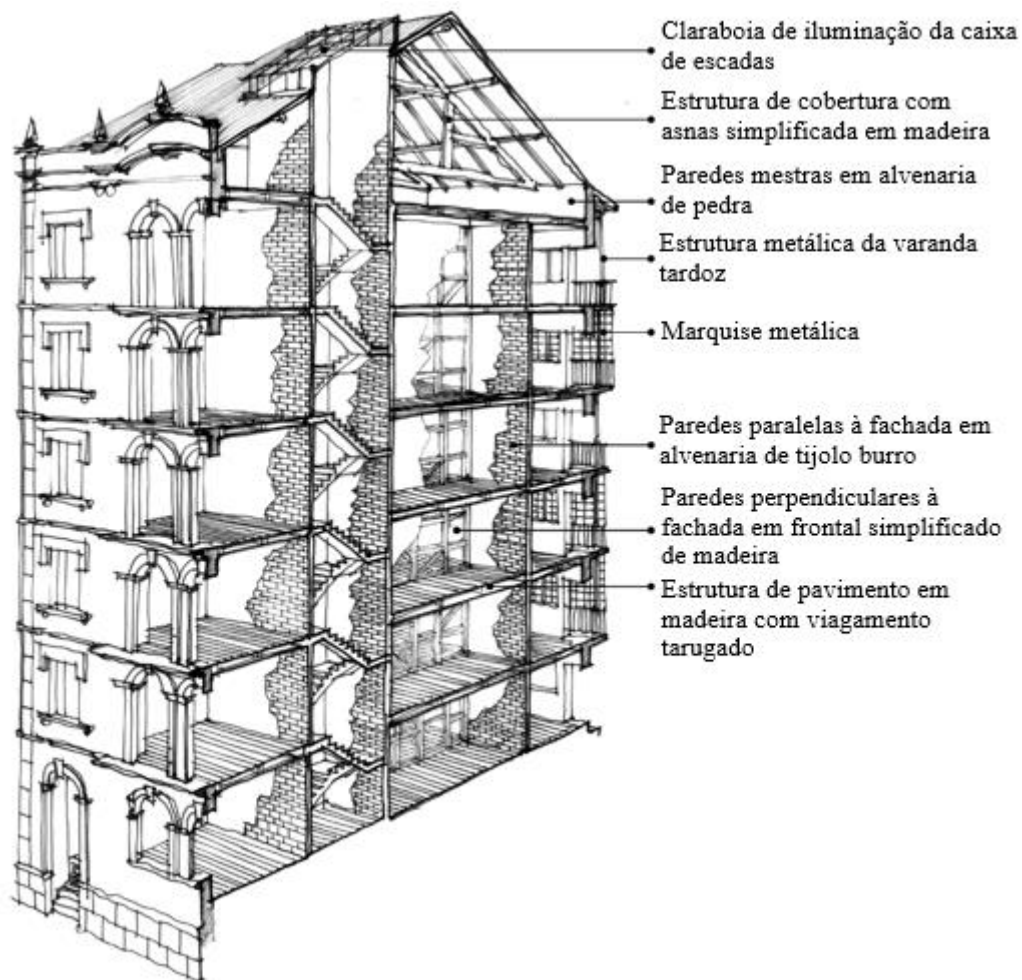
Arquétipo estrutural gaioleiro (Ordem dos Arquitectos, 2016).
